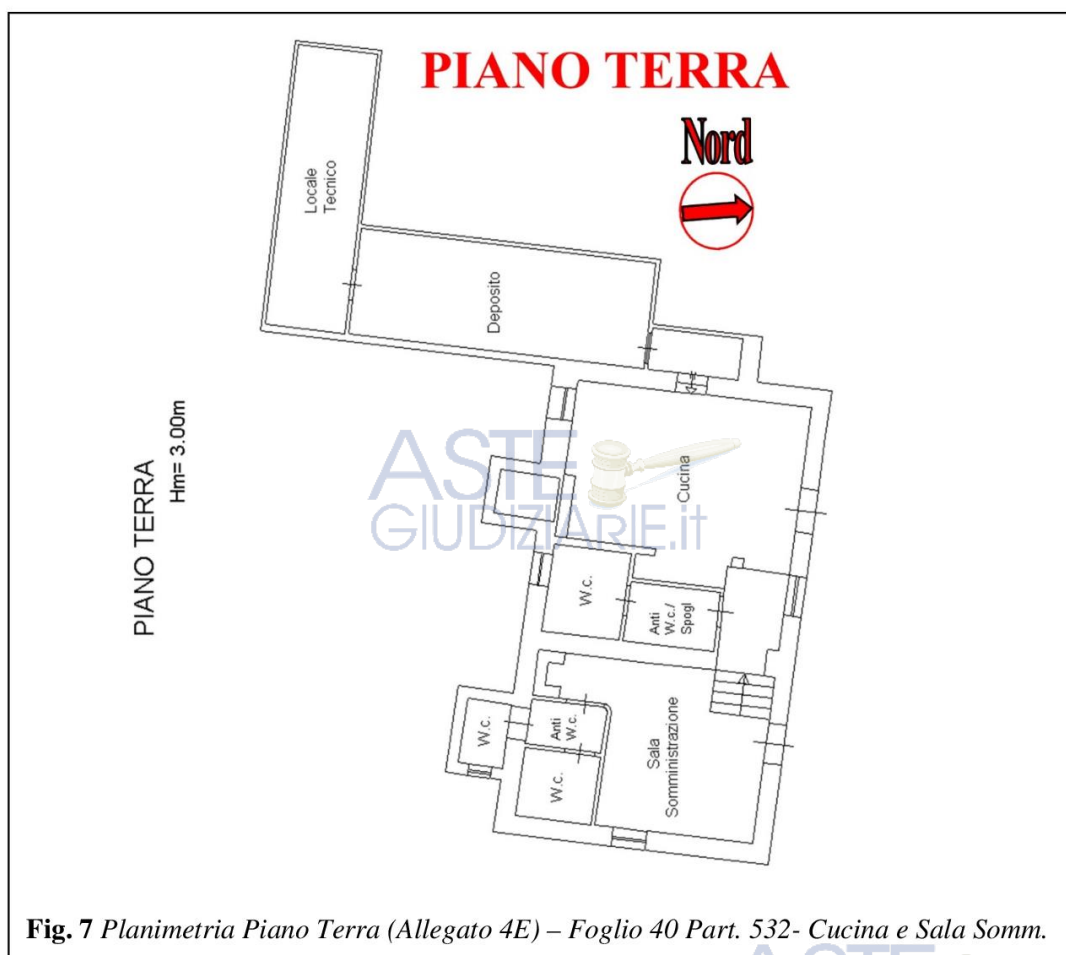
Planimetria Piano Terra (Allegato 4E) – Foglio 40 Part. 532- Cucina e Sala Somm.
